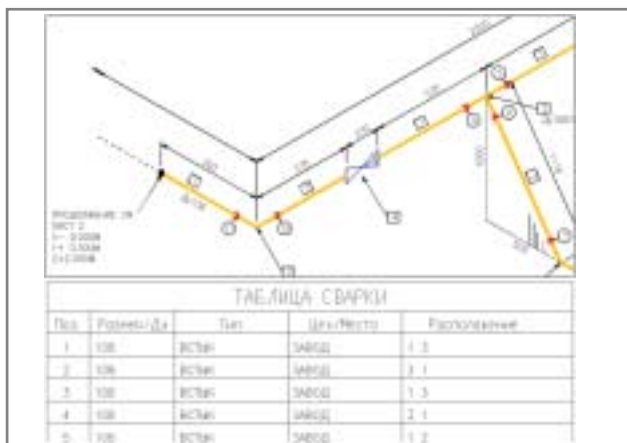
Фрагмент монтажной изометрии с нумерацией швов и таблицей сварки
